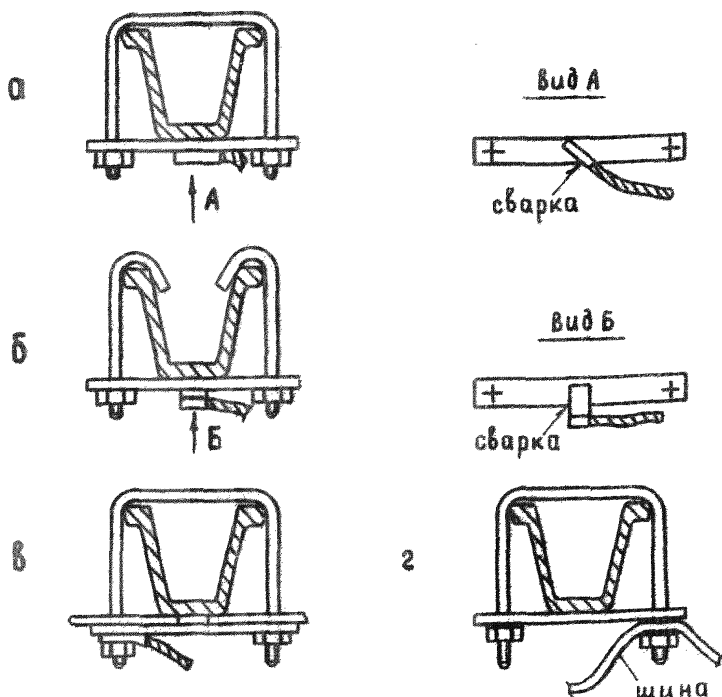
Примеры присоединения соединительных проводников к стойкам рам и репы: а),б)- присоединение сварной с помощью планок и скоб (хомутов) различной конструкции; в)- разъемное резьбовое соединение скобы с наконечником соединительного проводника; г)- резьбовое соединение скобы со обратной шиной - соединительным проводником
